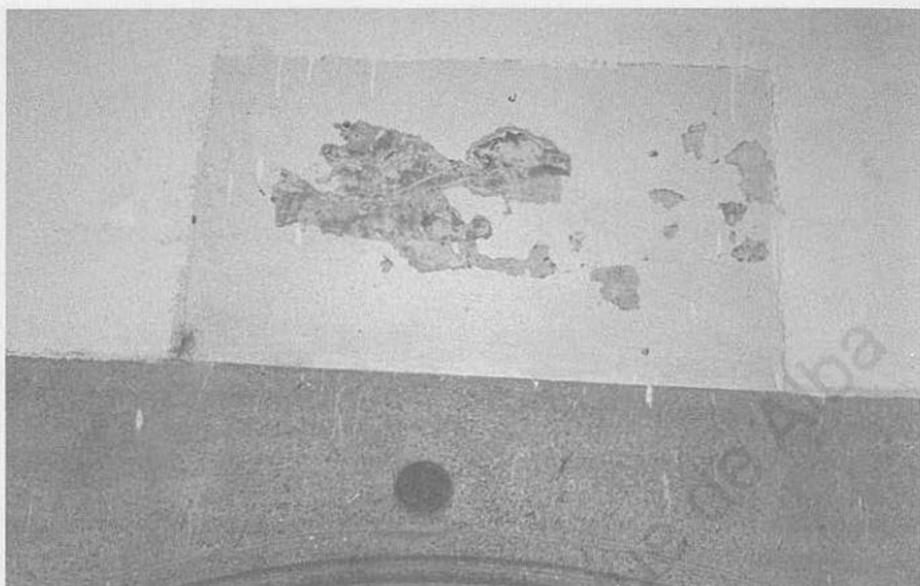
Claustro de los Reyes. Panda este. Corredor inferior. Muro este-lado oeste. Detalle de la decoración de los vanos del piso intermedio. Octubre 2003.
